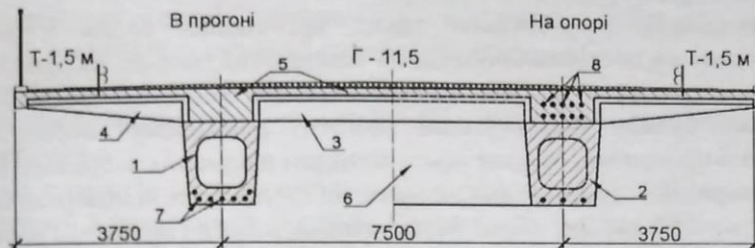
Двобалкова нерозрізна збірно-монолітна залізобетонна прогонова будова моста для складних умов будівництва: 1 - збірна прогонова балка; 2 - монолітна або збірна надпорна балка; 3 - збірна ребриста плита; 4 - збірна ребриста консольна плита; 5 - бетон замонолічування головних балок і плити; 6 - монолітна діафрагма в стиках і над опорами; 7 - напружувана арматура збірних балок; 8 - напружувана арматура надпорних зонах і стиках
